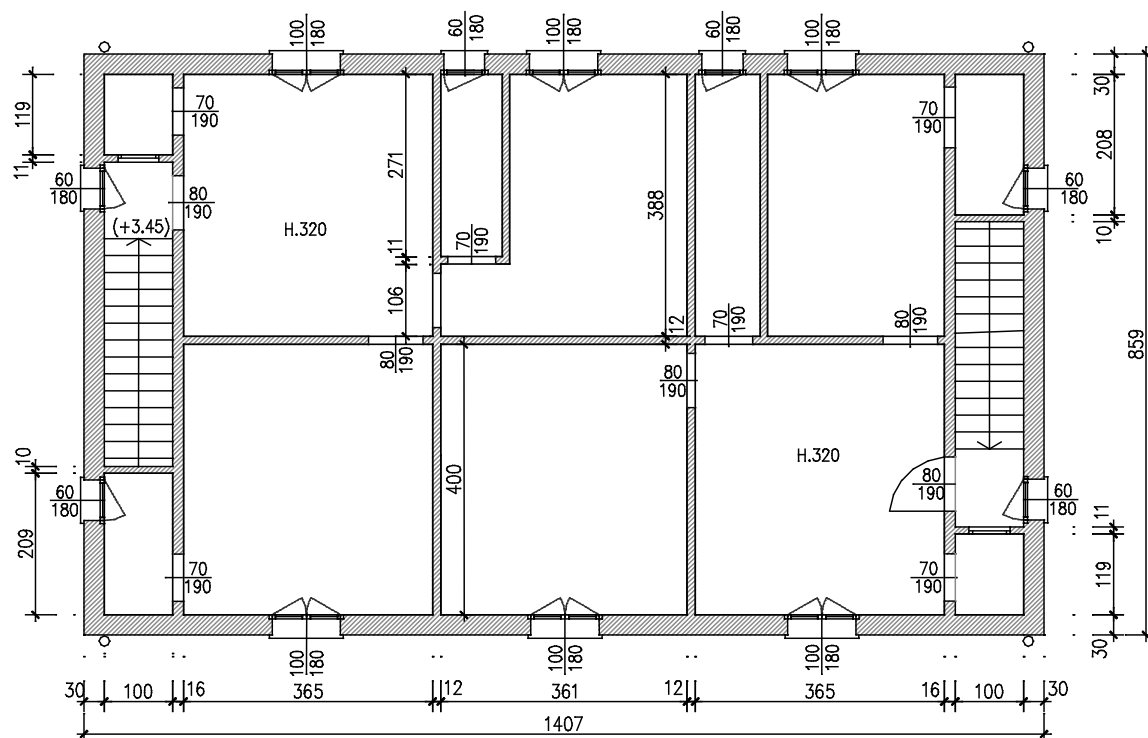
PALAZZINA TIPO B: Pianta Piano Primo – Stato di Fatto
